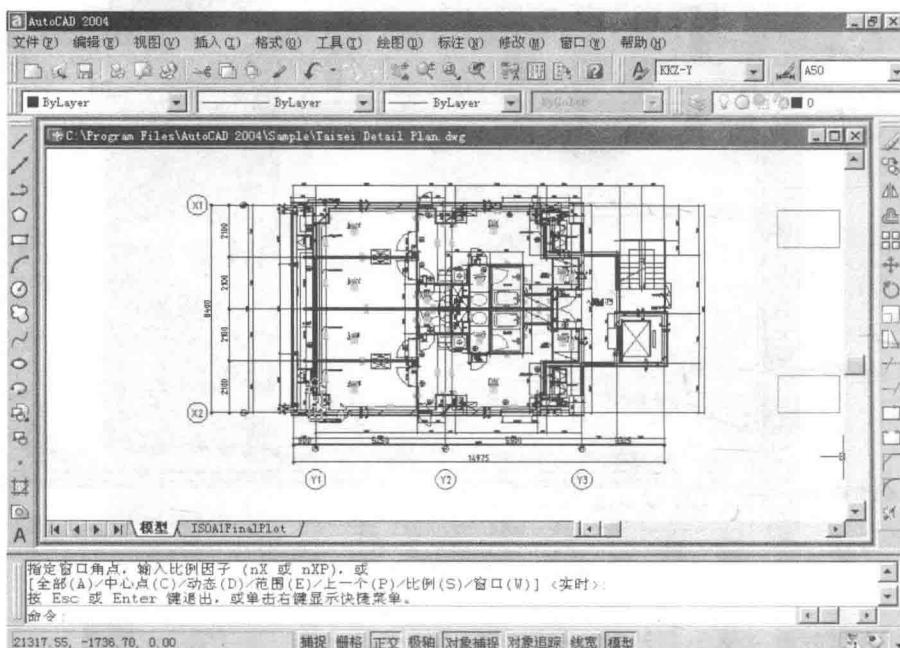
“Taisei Detail Plan.dwg”文件所有图形
